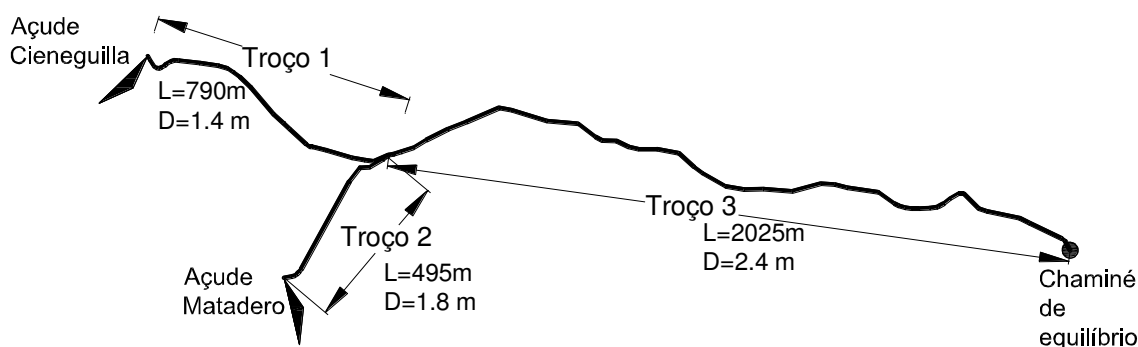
Planta esquemática da conduta em baixa pressão – solução 2.
